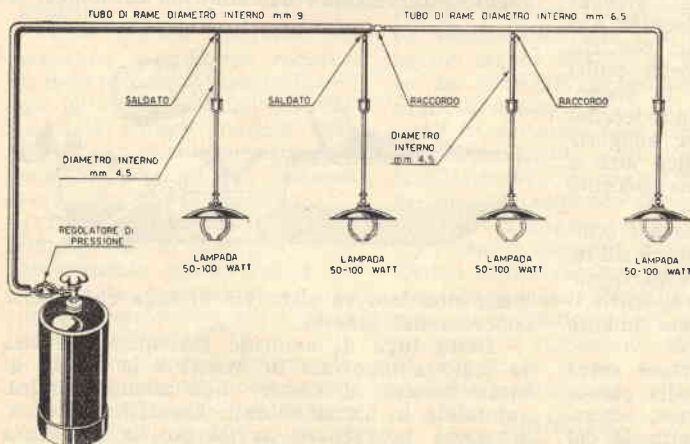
Impianto di 4 lampade da 50-100 candele con tubo in rame a diametro decrescente
